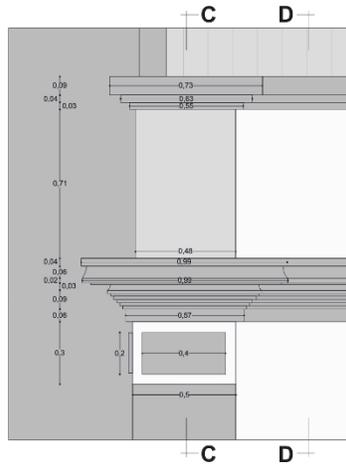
Detalle cornisa, Estación del ferrocarril Sur.
